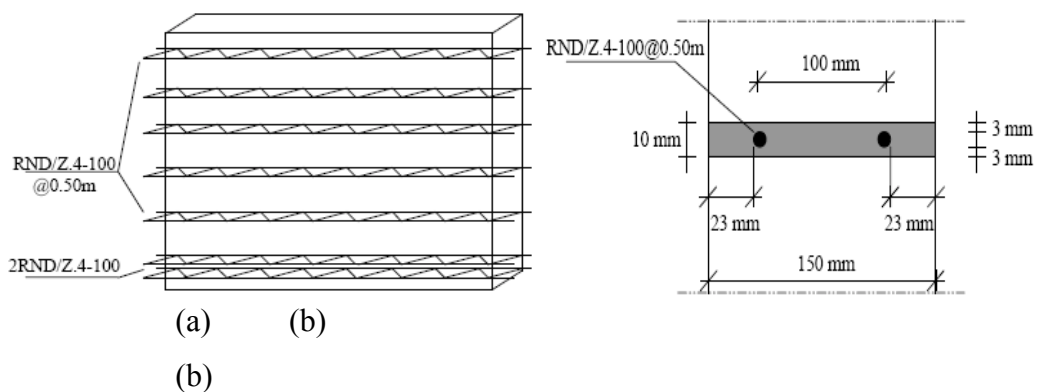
Exemplo de uma parede (com espessura de 15 cm) reforçada com armadura de junta para controle da fissuração: (a) distribuição da armadura ao longo da parede; (b) detalhes da junta de assentamento (seção transversal) – LOURENÇO, 2008.
